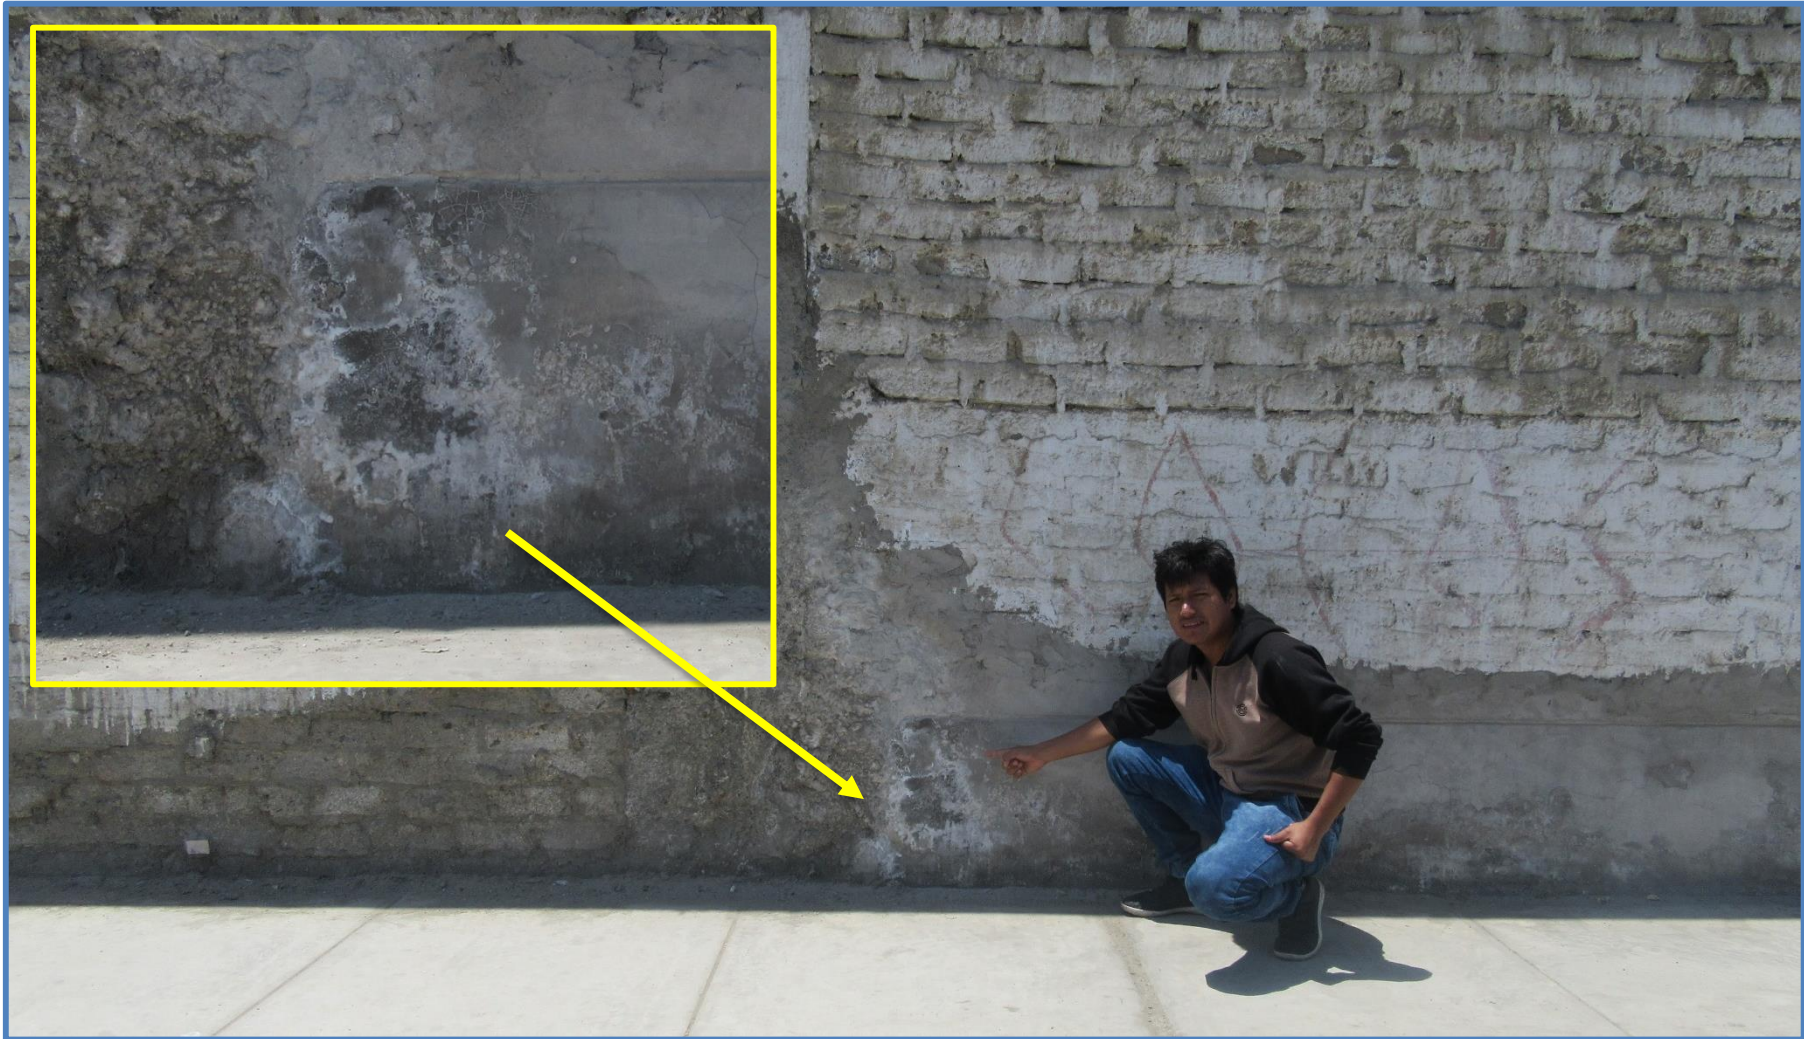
En esta imagen se observa la patología fisura, con nivel de daño bajo y está localizado en la unidad de muestra 08.
